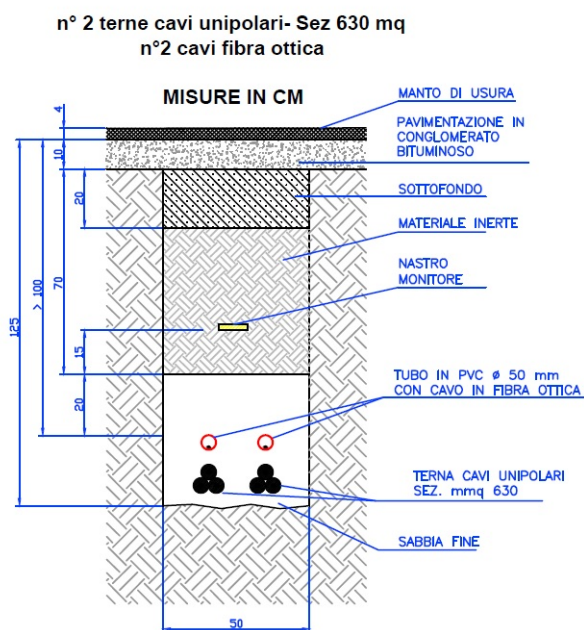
Sezione tipo cavidotto con doppia terna di cavi unipolari su strada asfaltata estraparco
